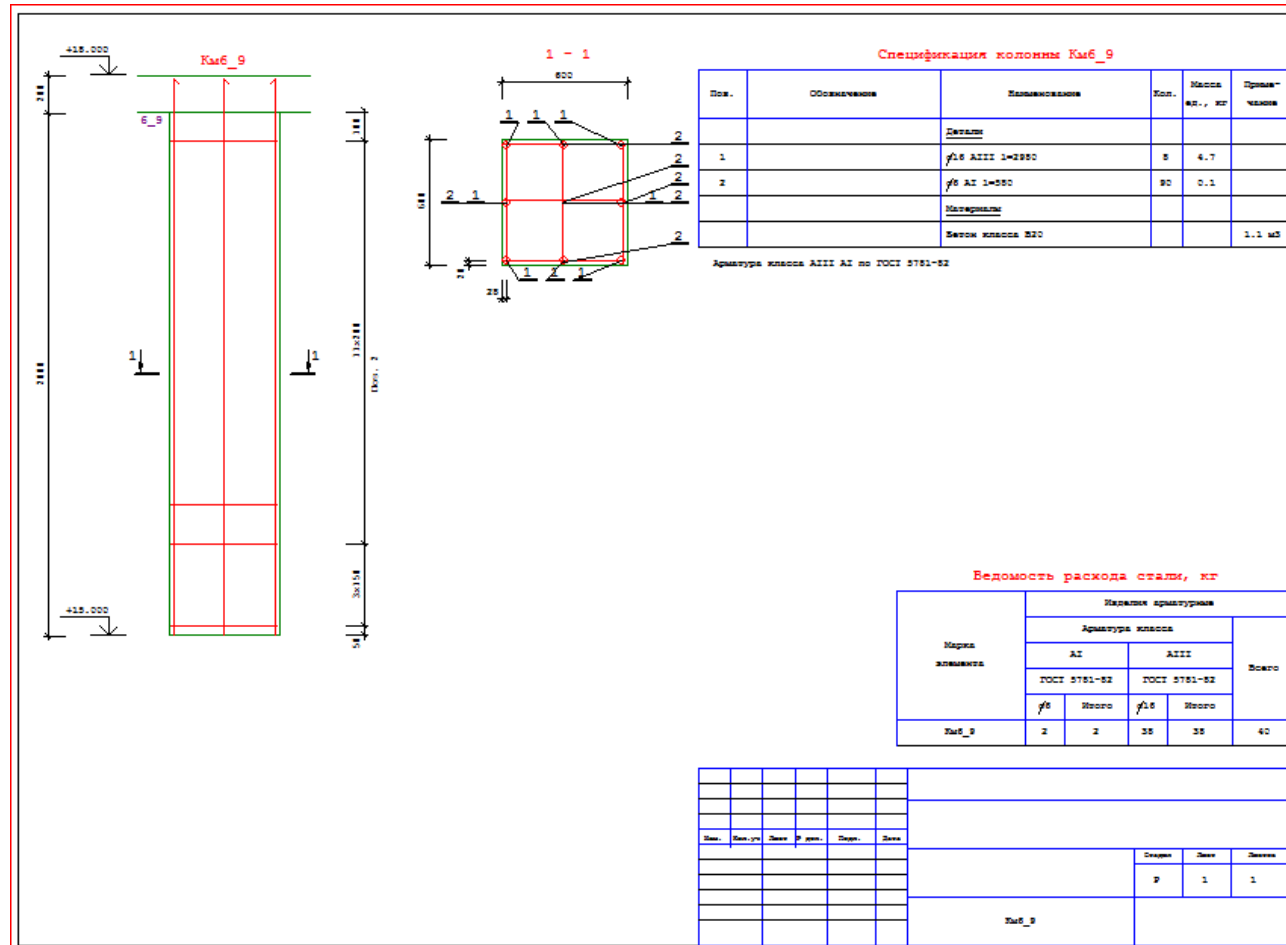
Вариант плитного перекрытия. Колонна К6.9. Креслення робочого проекту
